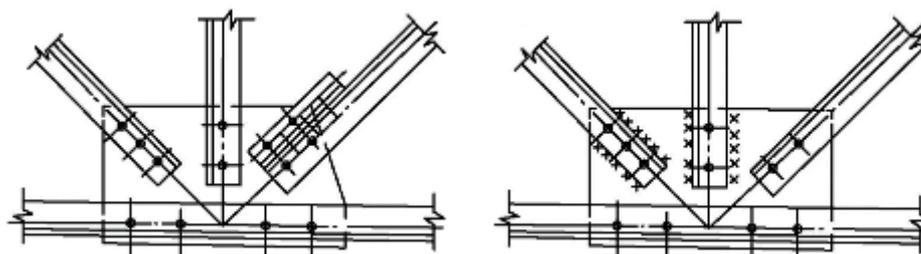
Усиление узла фермы 1-болтами, 2 — сварными швами
